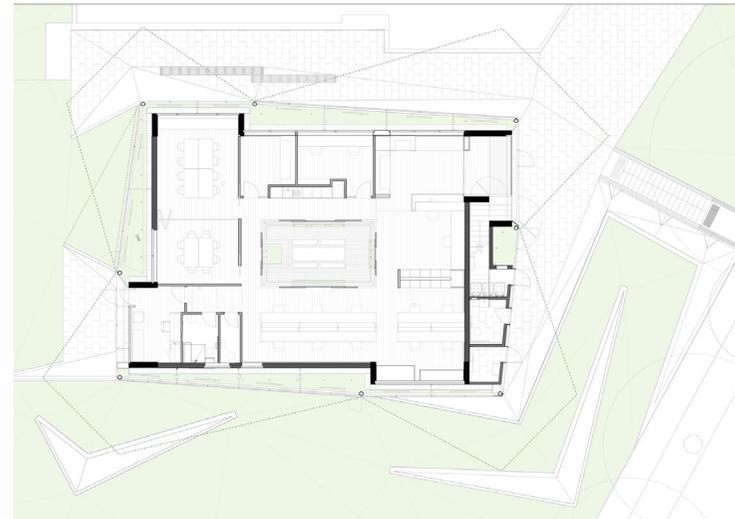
Grundriss Waterloo Jugendzentrum
